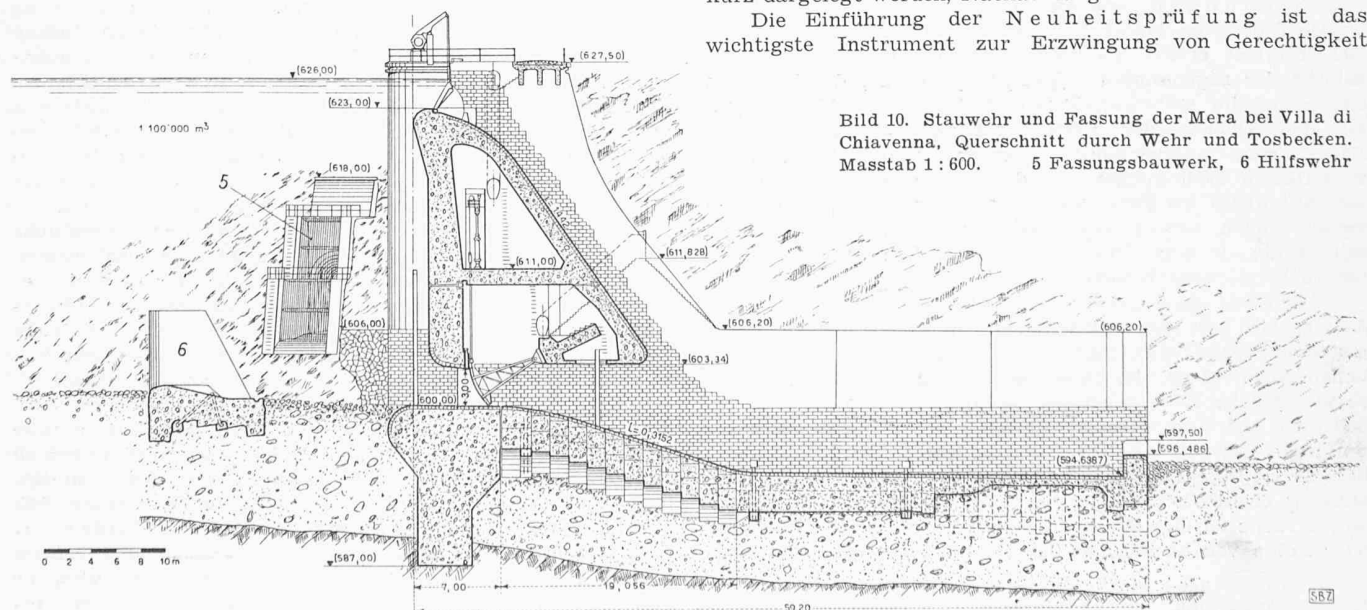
Stauwehr und Fassung der Mera bei Villa di Chiavenna, Querschnitt durch Wehr und Tosbecken. Masstab 1 : 600. 5 Fassungsbauwerk, 6 Hilfswehr
